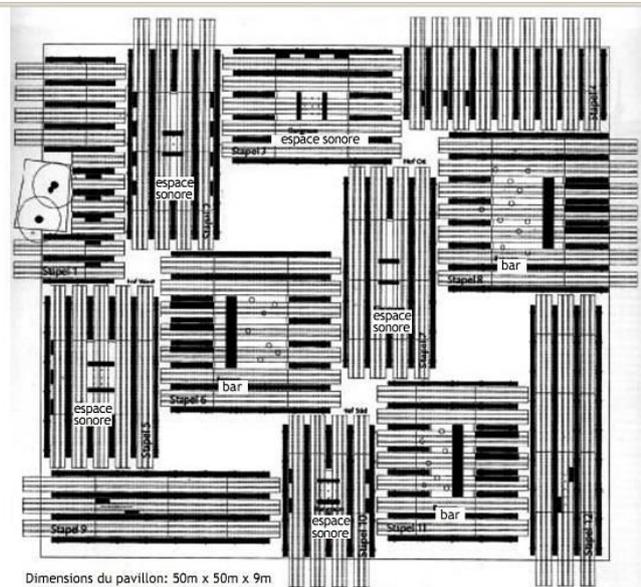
Swiss Sound Box Pavilion*. Foi construído para *World Hanover* em 2000 na Alemanha e após o encerramento da Expo, o edifício foi desmontado e as vigas foram vendidas como madeira experiente. Autor do projeto é o arquiteto Peter Zumthor. Fonte: <https://pt.wikiarquitectura.com/constru%C3%A7%C3%A3o/pavilhao-swiss-sound/>.
